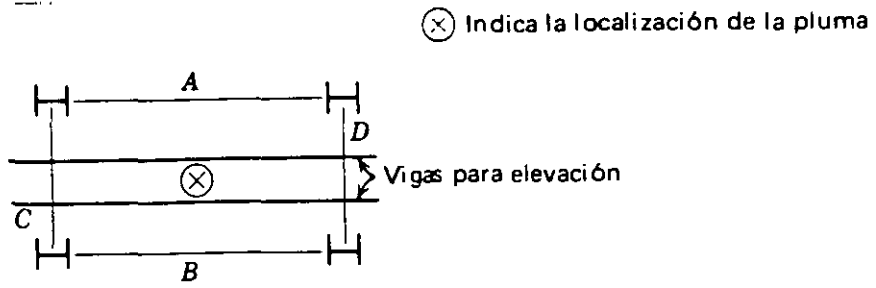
Colocación de las vigas para elevación. Arreglo normal; las vigas C y D son adecuadas para soportar carga en su parte central.
